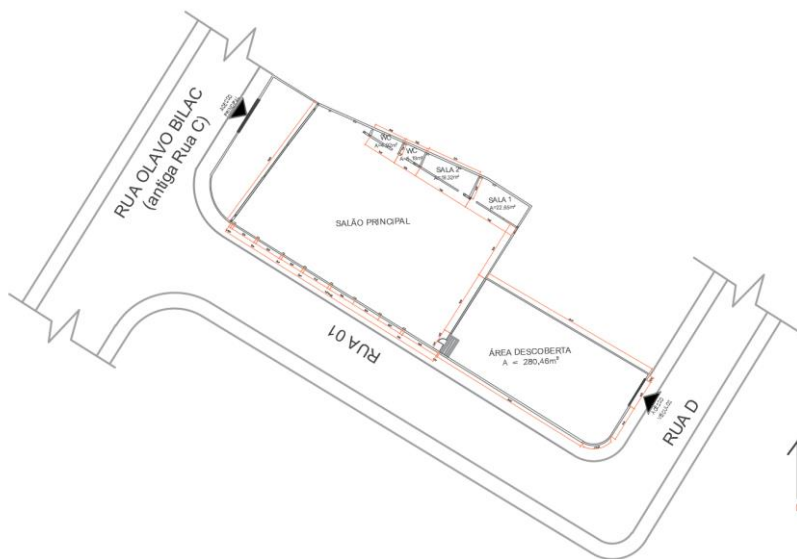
Planta Baixa do Imóvel / Fonte: Levantamento DIF
